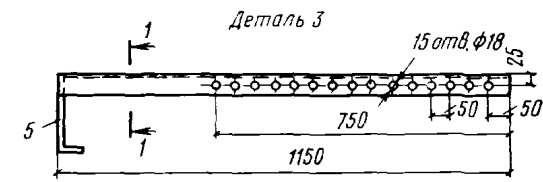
Подвесной хомут для крепления коробов опалубки железобетонных ригелей
